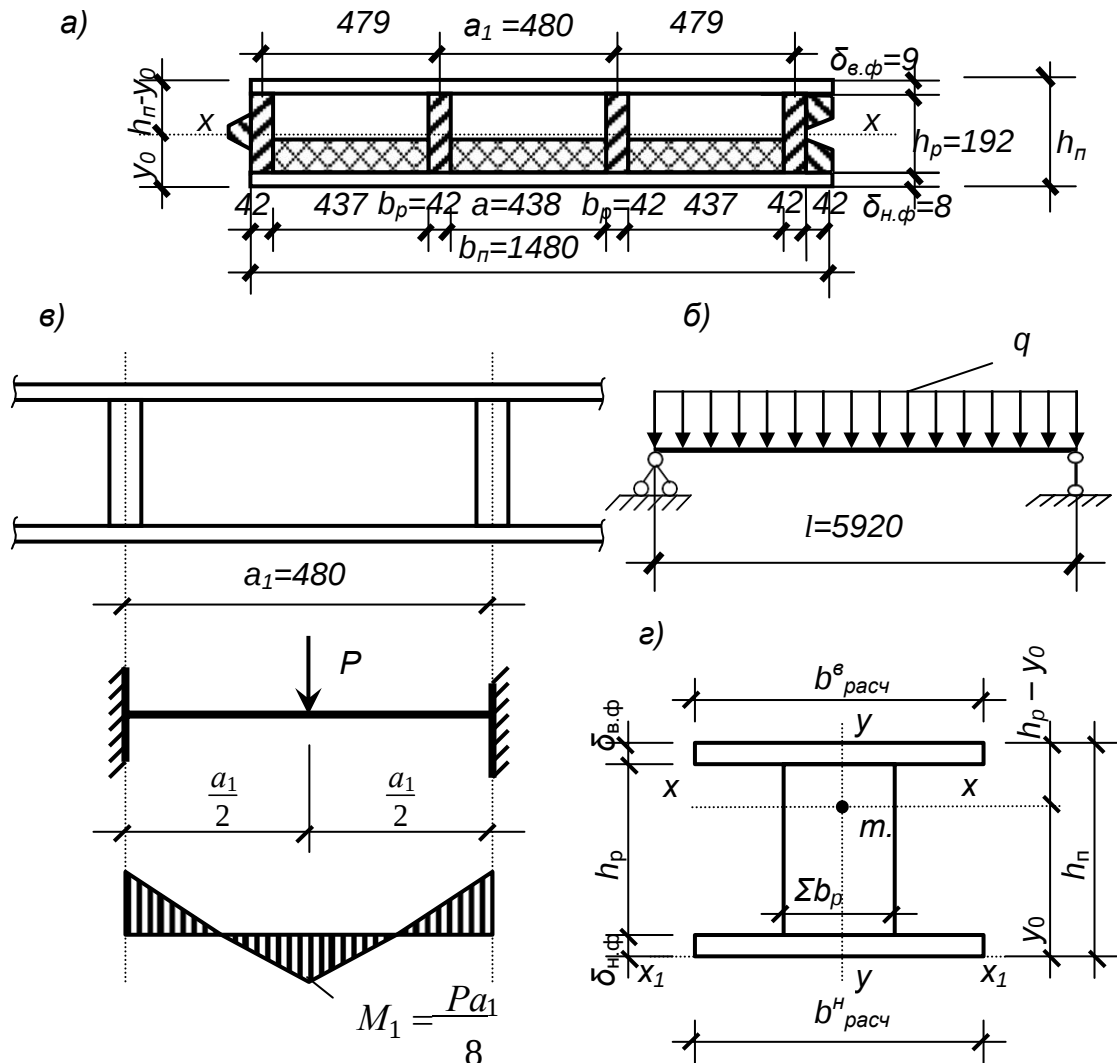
Поперечное сечение, расчетные схемы и расчетное сечение плиты: а – поперечное сечение; б – расчетная схема при действии равномерно распределенной расчетной нагрузки; в – конструктивная и расчетная схема при действии сосредоточенной нагрузки; г – приведенное поперечное сечение плиты
